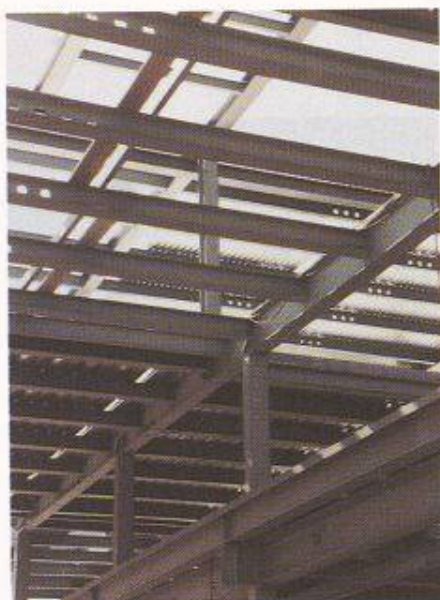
Haupthalle mit darüberliegender Kleinprüfhalle von innen
